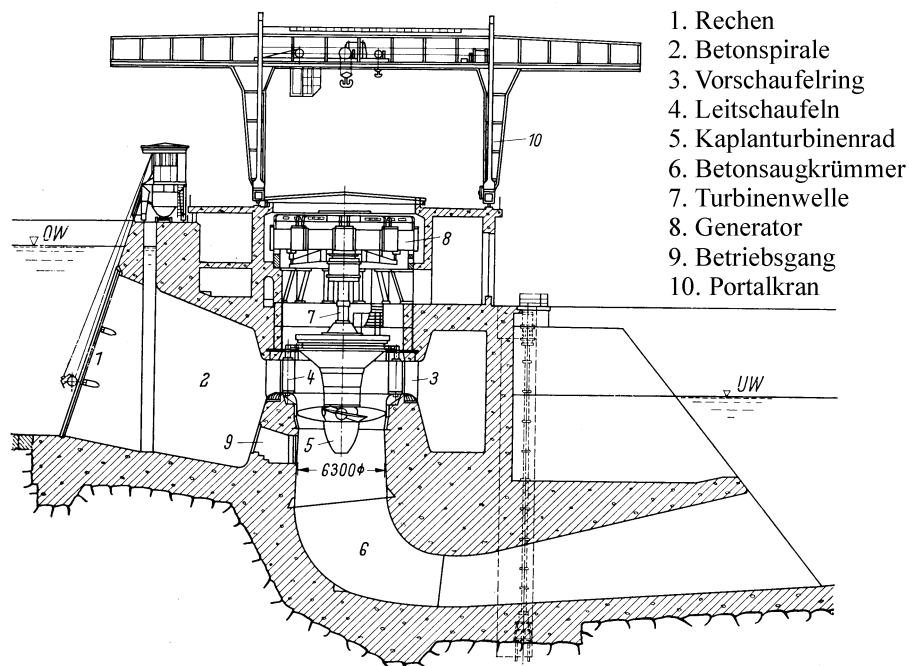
Schnitt durch ein Krafthaus mit einer Kaplan turbine (QUANTZ u. MEERWARTH 1963)
